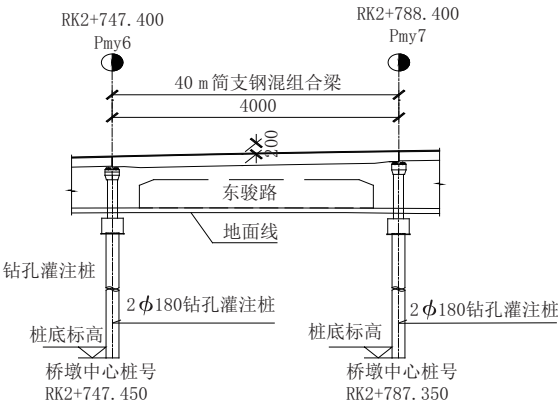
主线高架桥 40 m 简支钢-混组合梁总体布置图(单位:cm)
